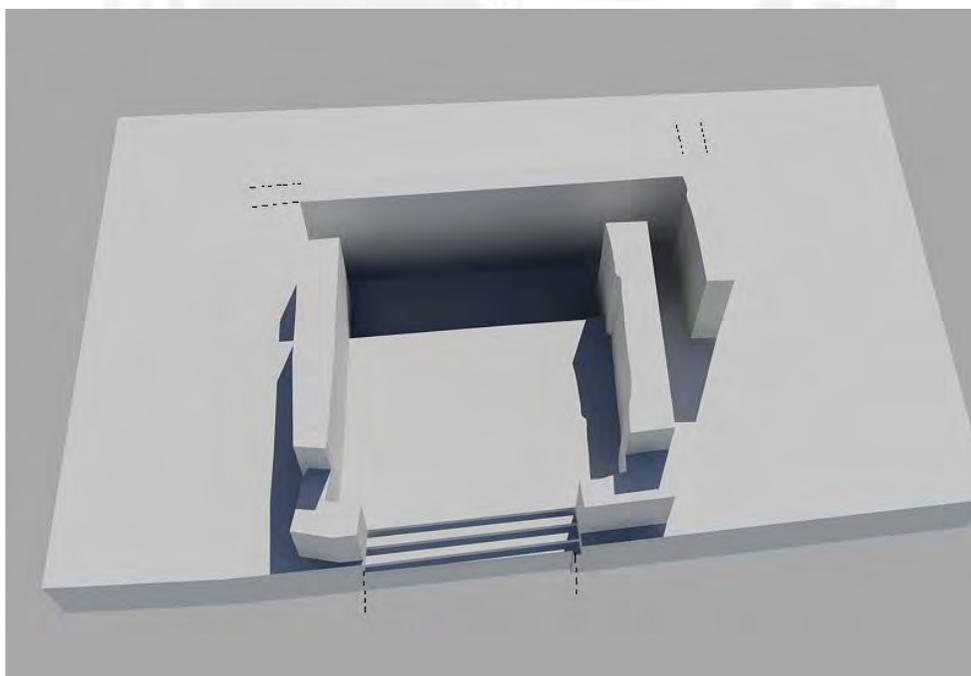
, Reconstrucción Isométrica de la Segunda fase constructiva del E1-Brazo derecho.
